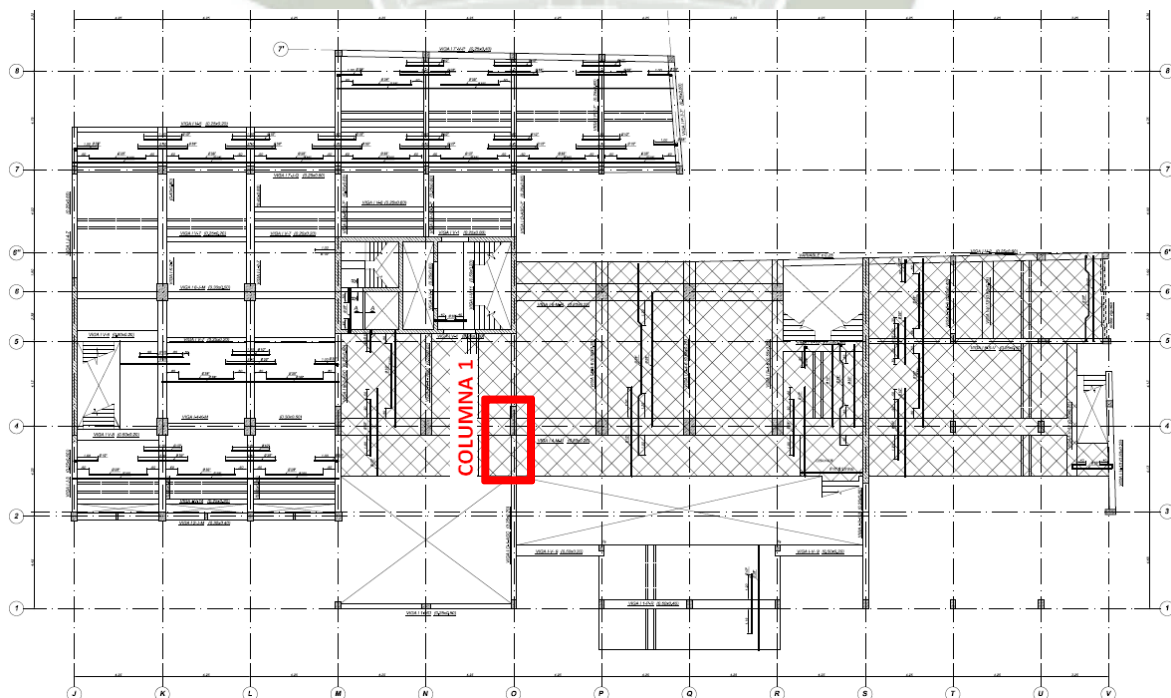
UBICACIÓN COLUMNA 1
